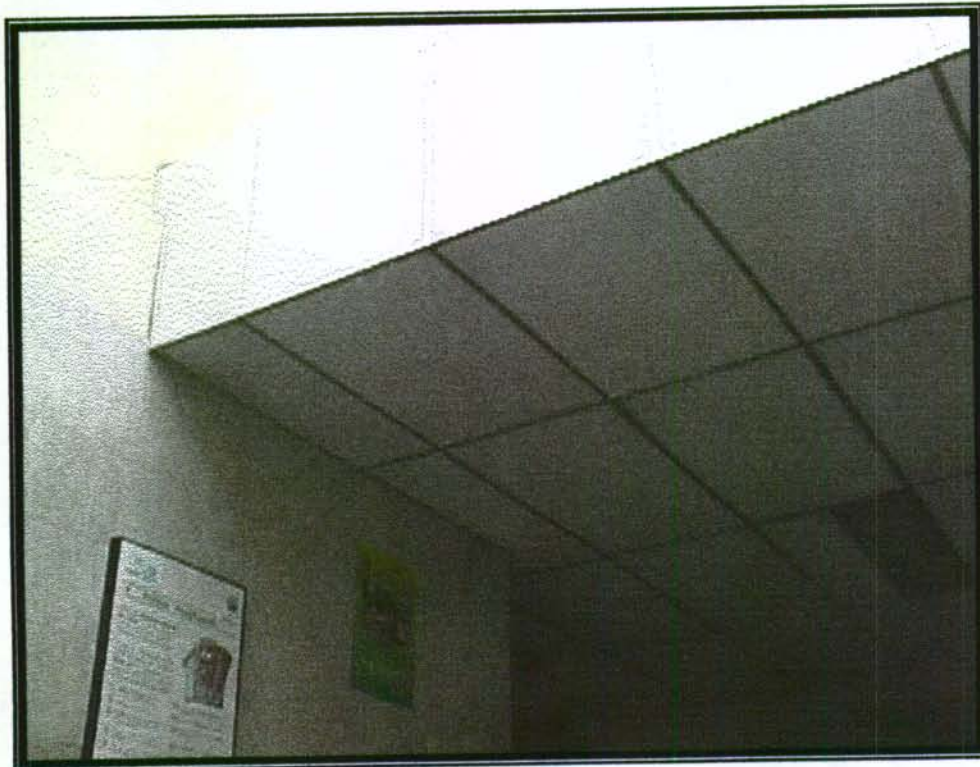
CIELO RASO FALSO – ZONA DE CONSULTA EXTERNA
